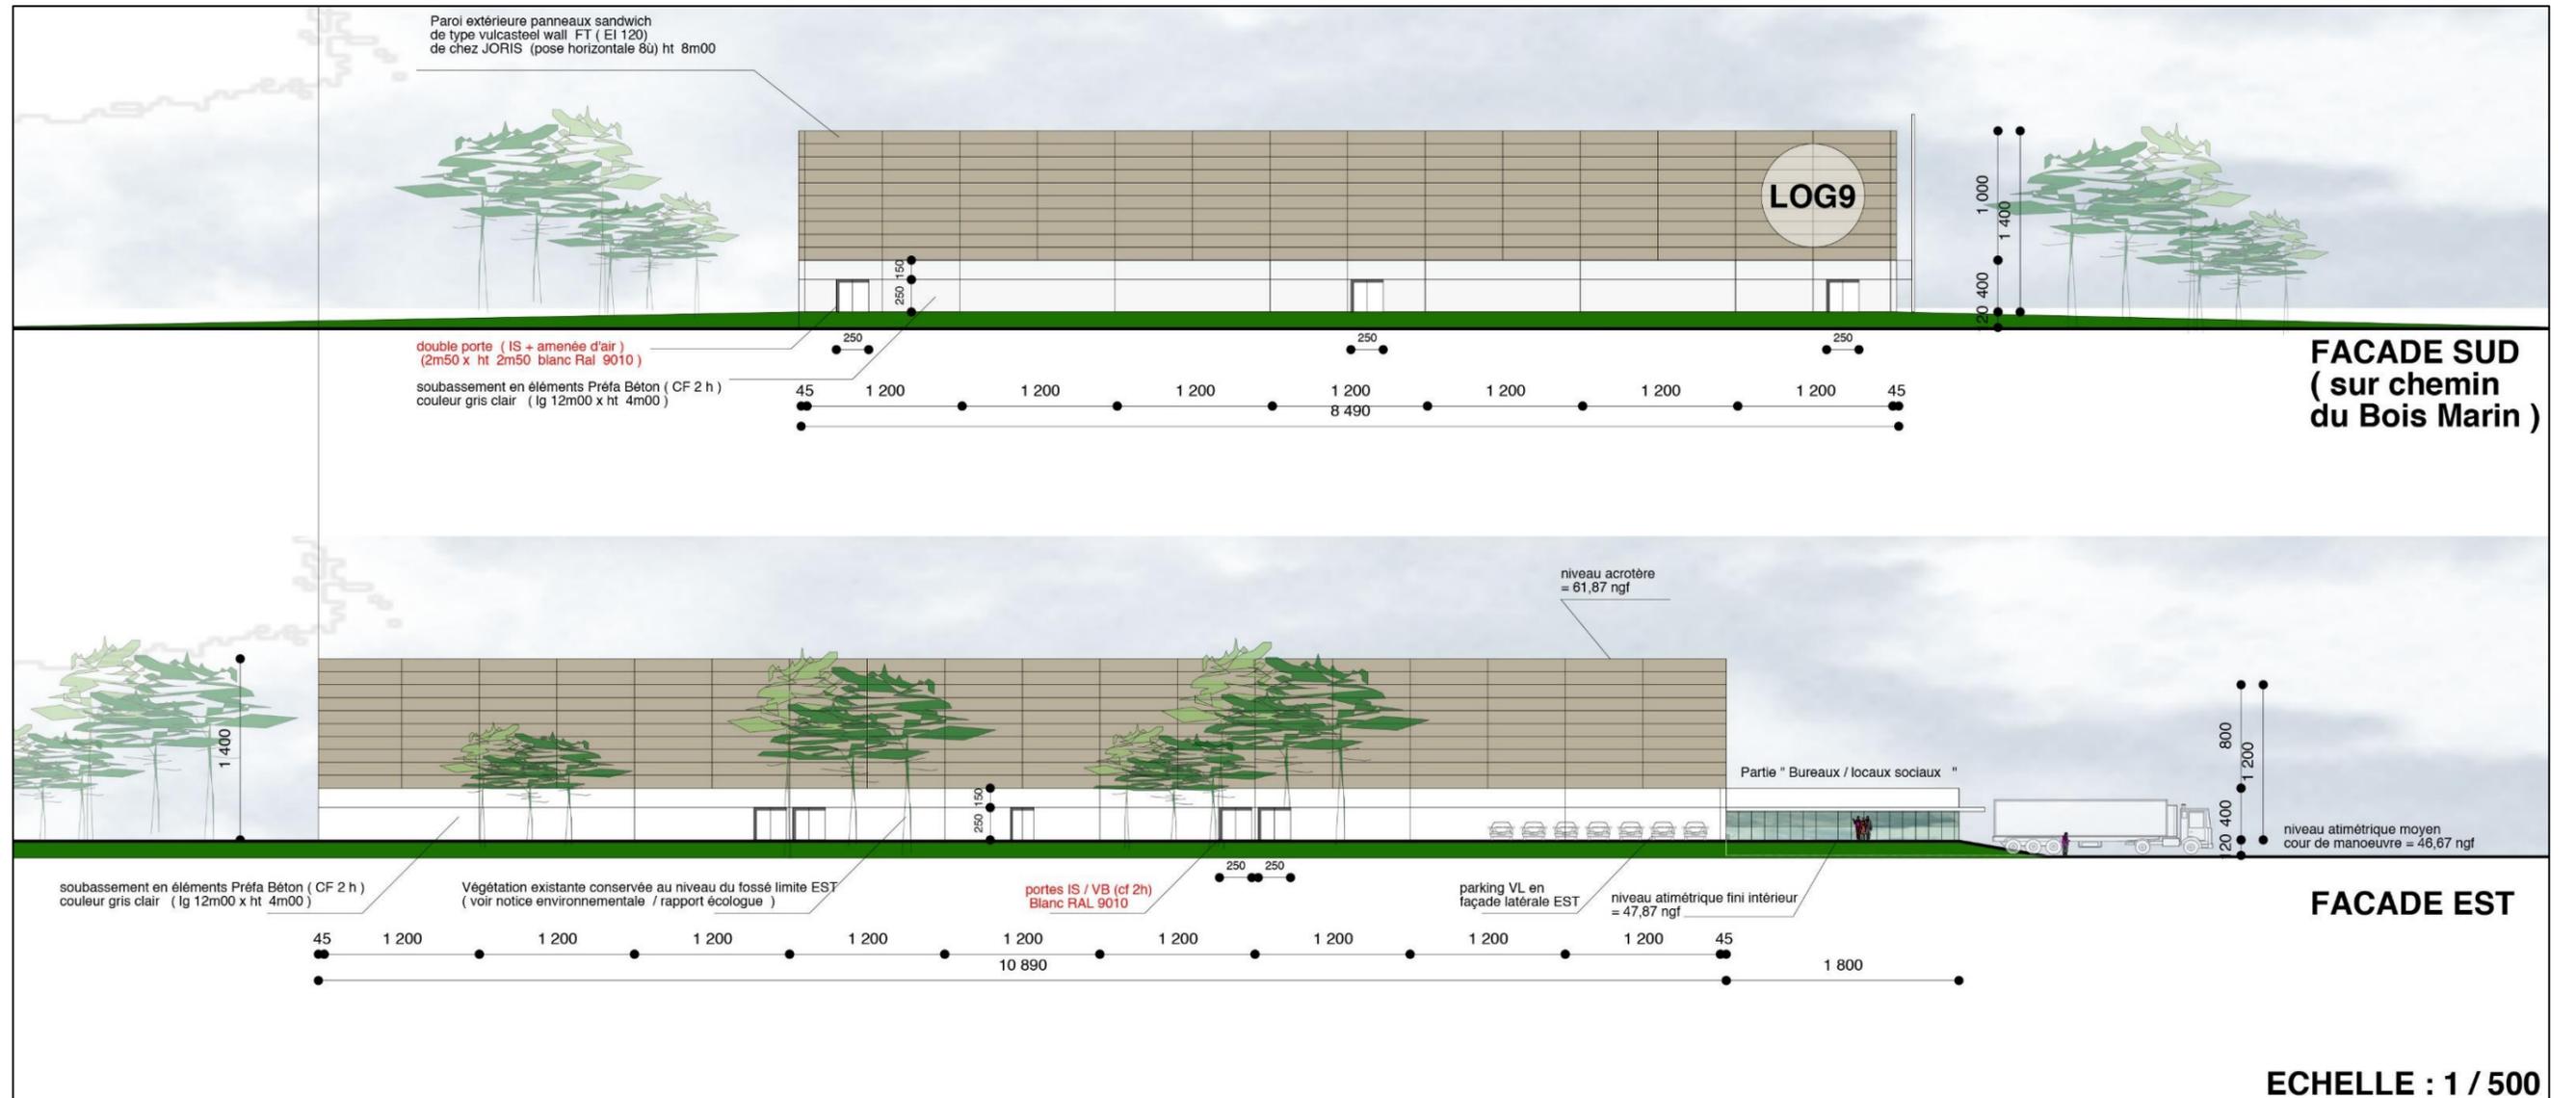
façades Sud et Est (Extrait du PC – H.SALADIN Architecte)
